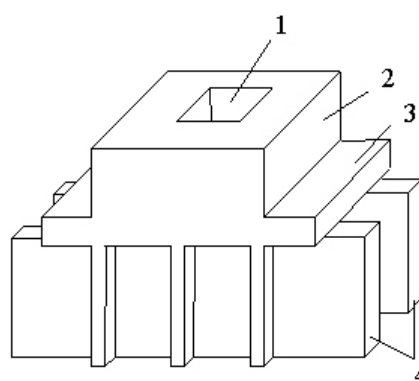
Щелевой пространственный фундамент: 1 – стакан; 2 – подколонник; 3 – плитная часть; 4 – вертикальные стенки
